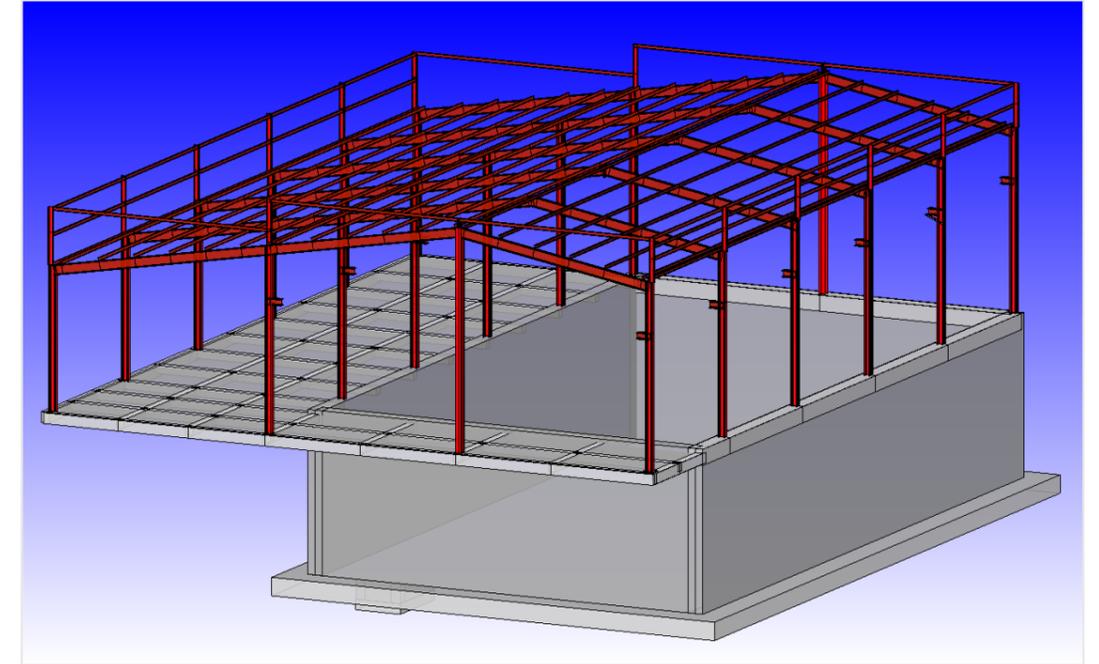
Modelización 3D de la estación de bombeo a riego. Cálculos estructurales
